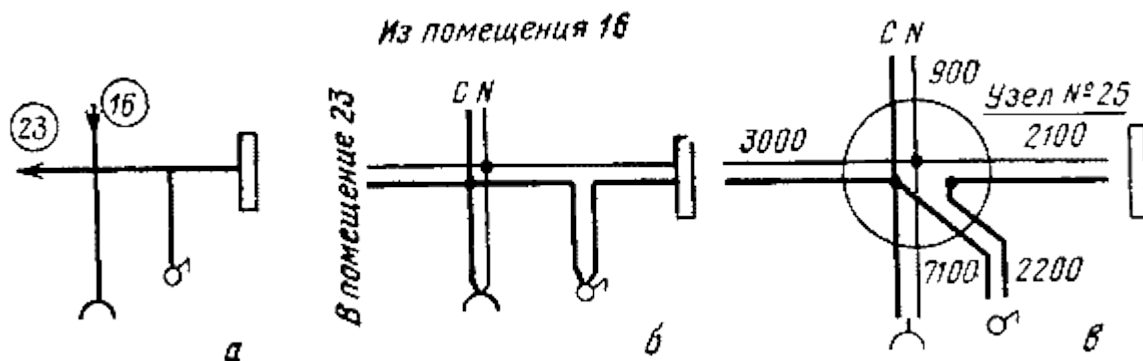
Схемы соединения осветительной электропроводки в узле № 25:
